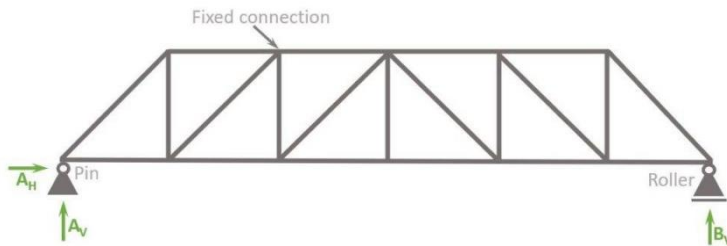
Estructura articulada tipo Howe. Fuente: <https://www.structuralbasics.com/howe-truss/>
